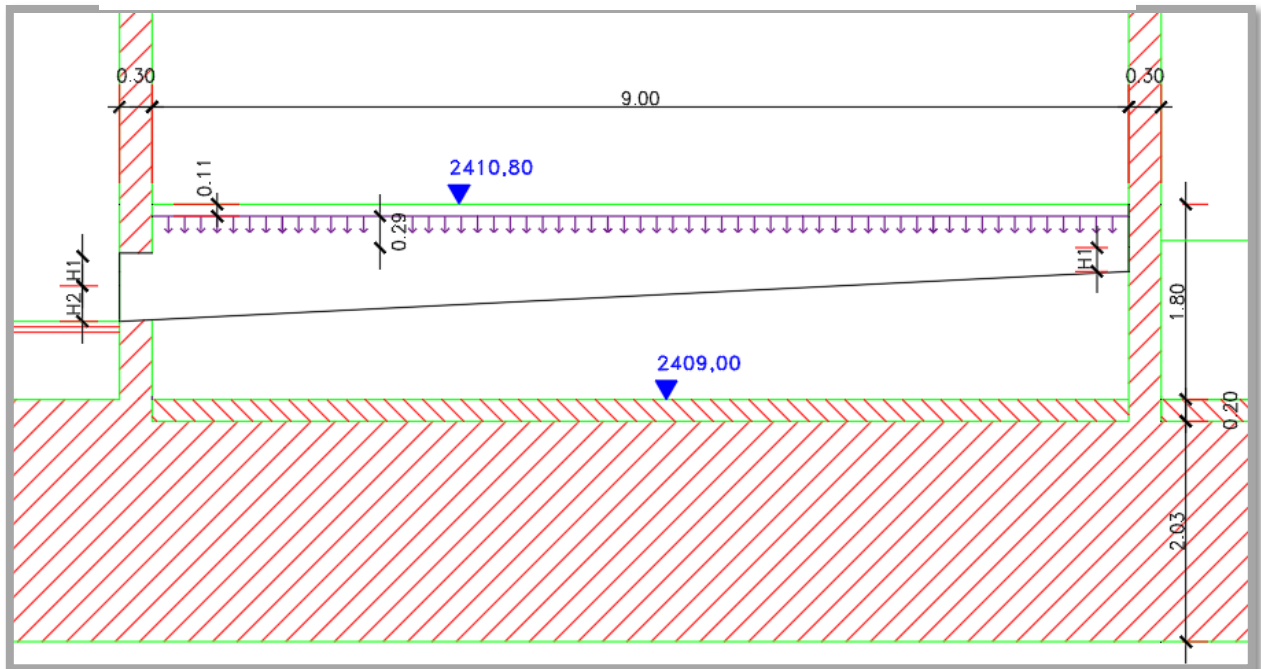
Vista de corte de la Galería conociendo el ancho de la malla
